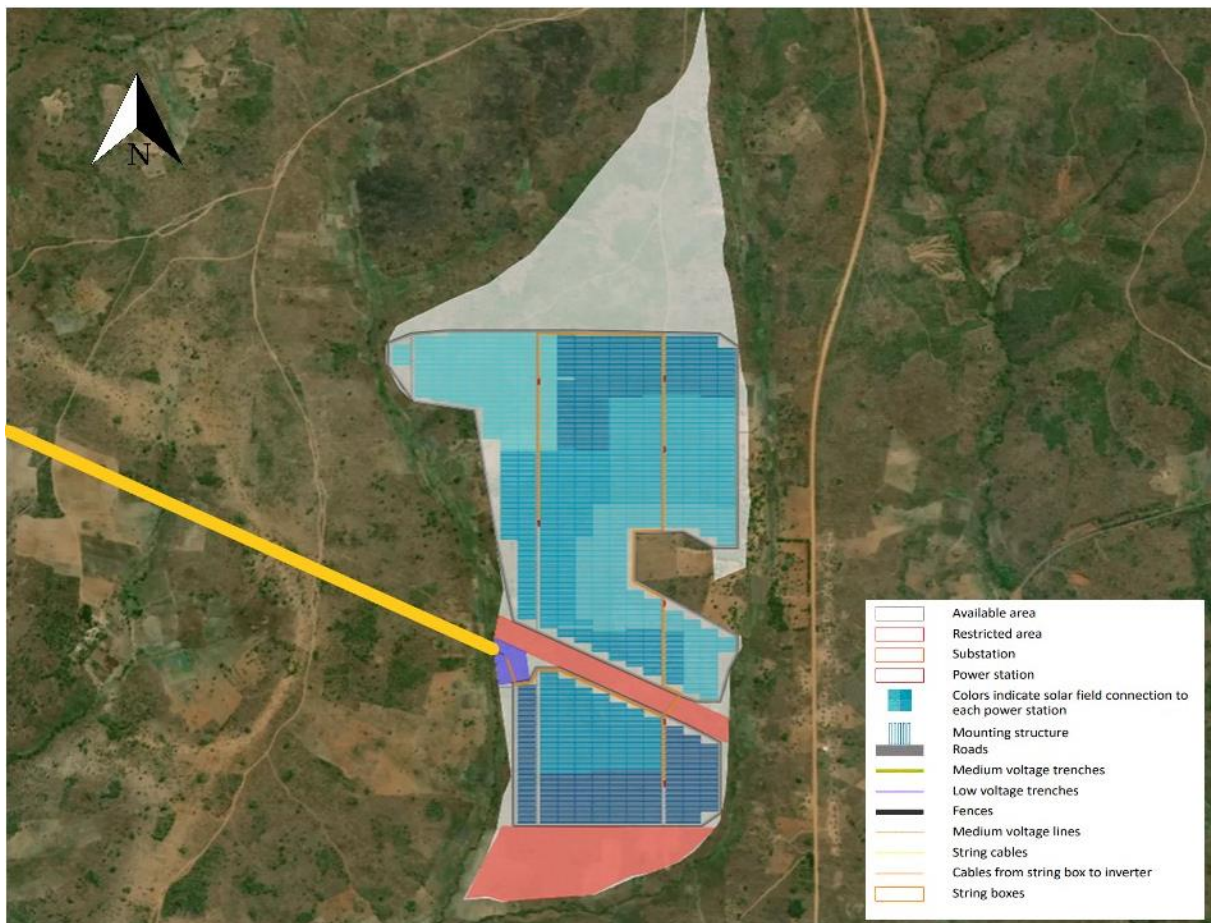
Layout da planta PV (montagem fixa), Chimburnila, Niassa (Alternativa)
